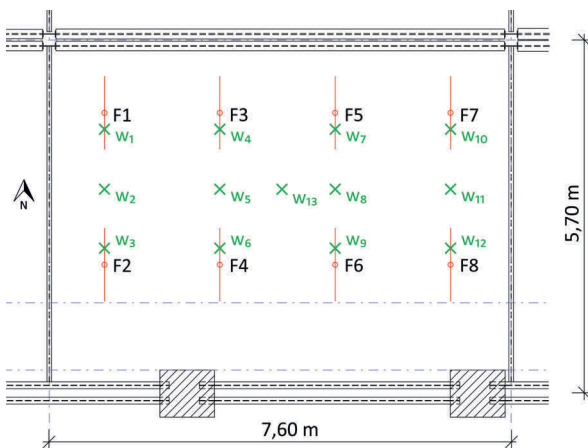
Messstellenplan der zu prüfenden Geschossdecke; hier: Decke über 2. Obergeschoss – PB4
